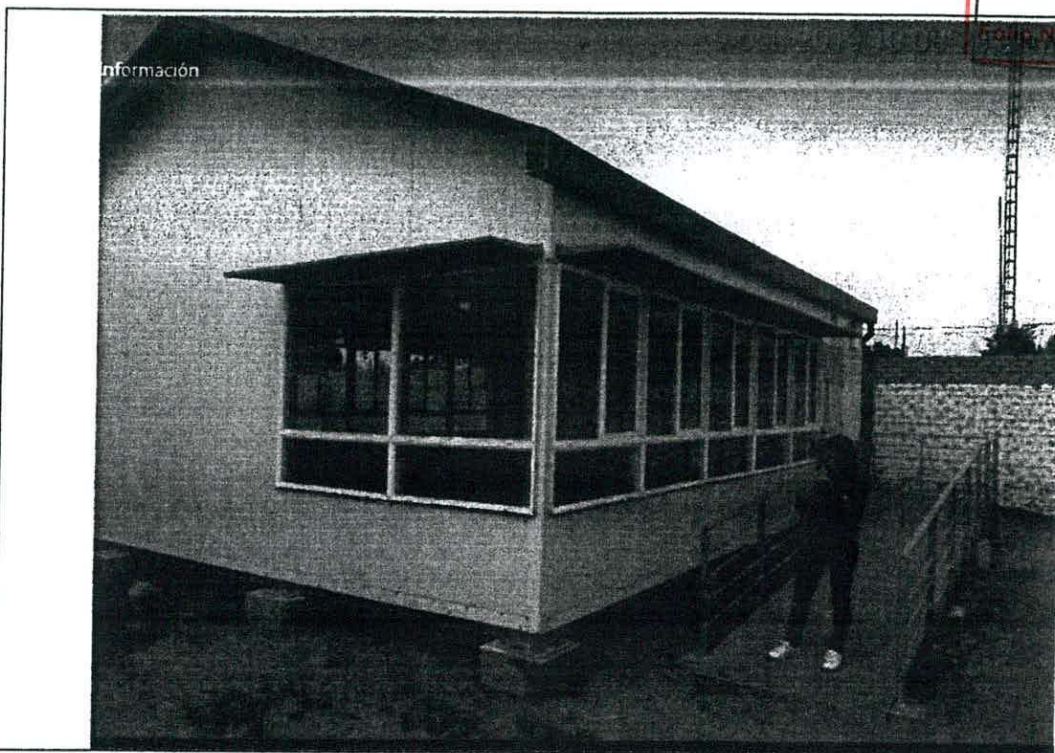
Modulo de aulas instalada en el año 2018 por PRONIED.
